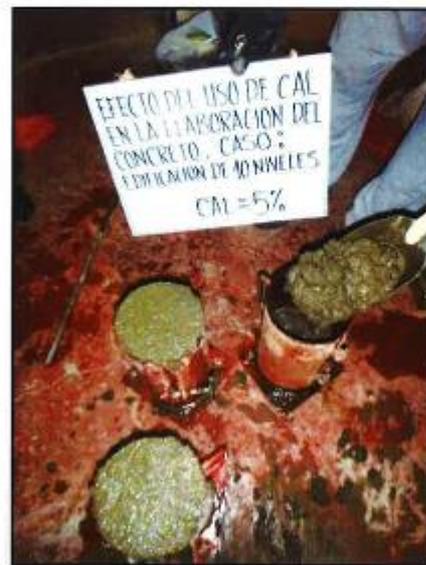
Elaboración de las probetas con 5% de Cal.
